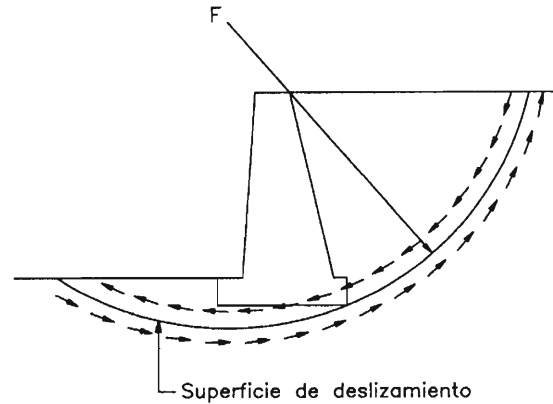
Falla por deslizamiento del muro y del terreno adyacente
